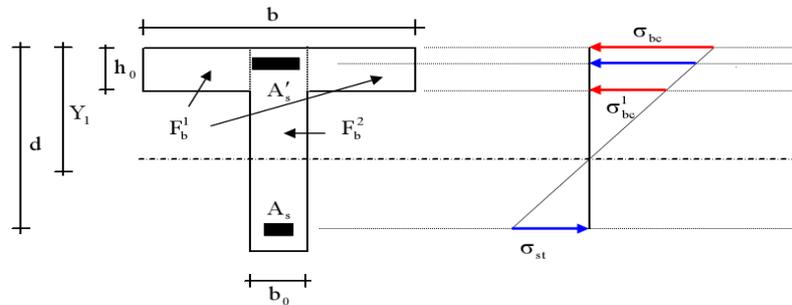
notation utilisées pour le calcul de section d’acier pour une poutre en T
